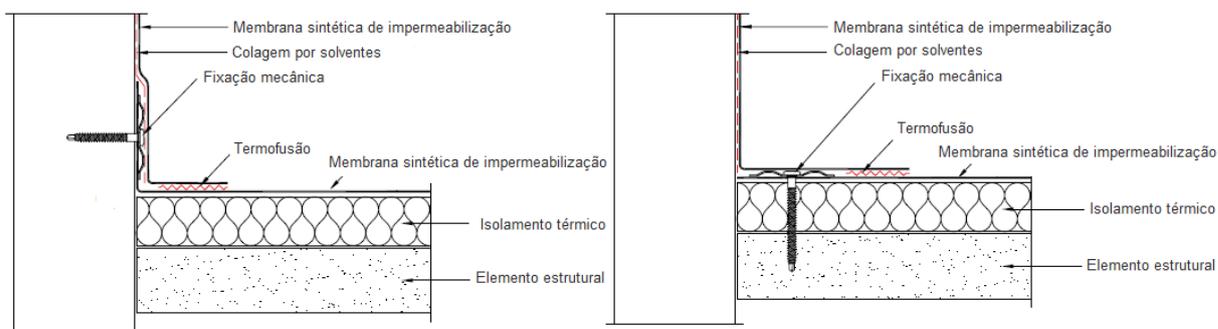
Pormenores de fixação da membrana com elementos verticais (Firestone@ 2013)
